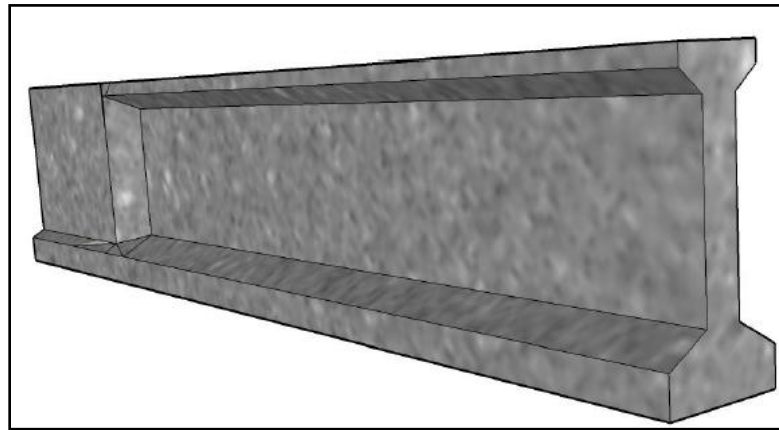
Allure de la poutre IM.3 S.A.P.T.A
